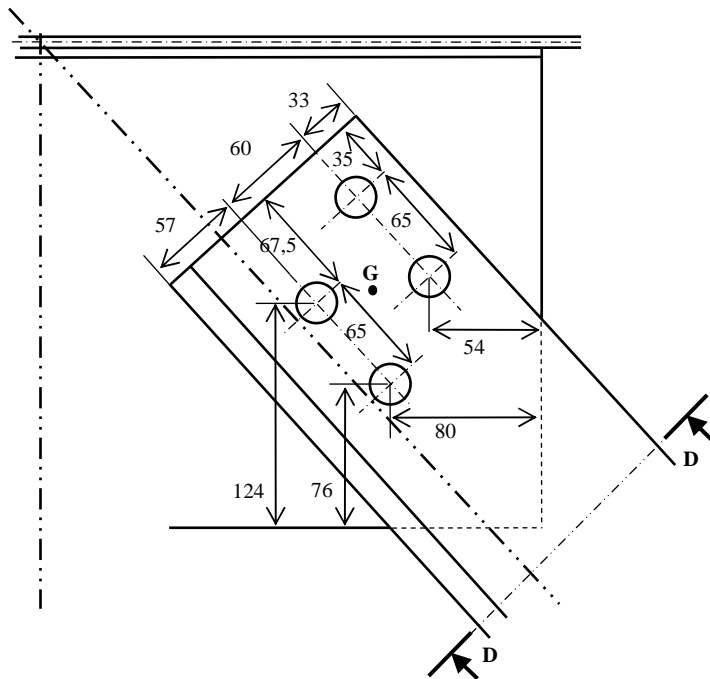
Unión N1 - Dimensiones (en mm) y posicionamiento
